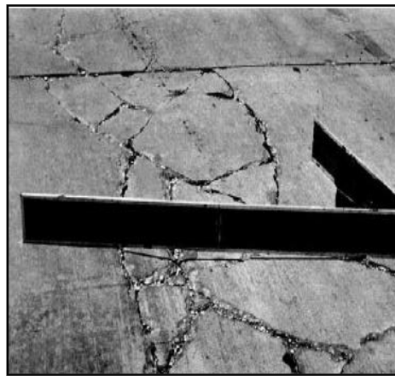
Esquema Punzonamiento (Punchout) - Pavimento Rígido
